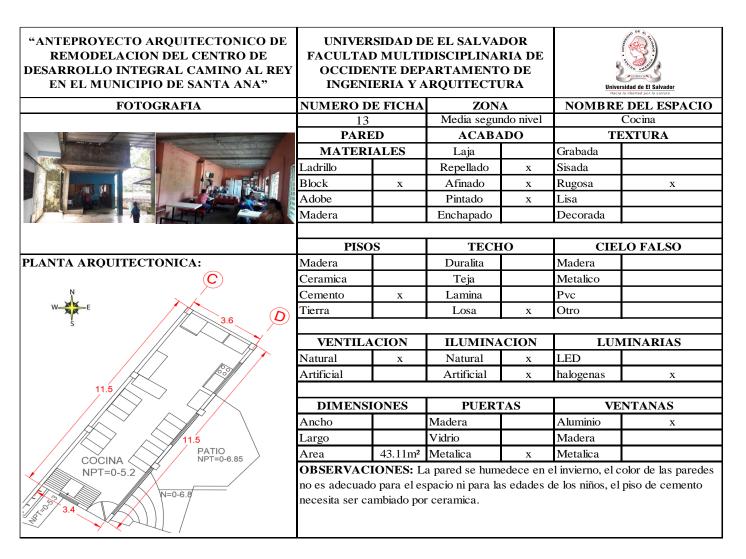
Planta arquitectónica media segundo nivel. Elaboración propia
